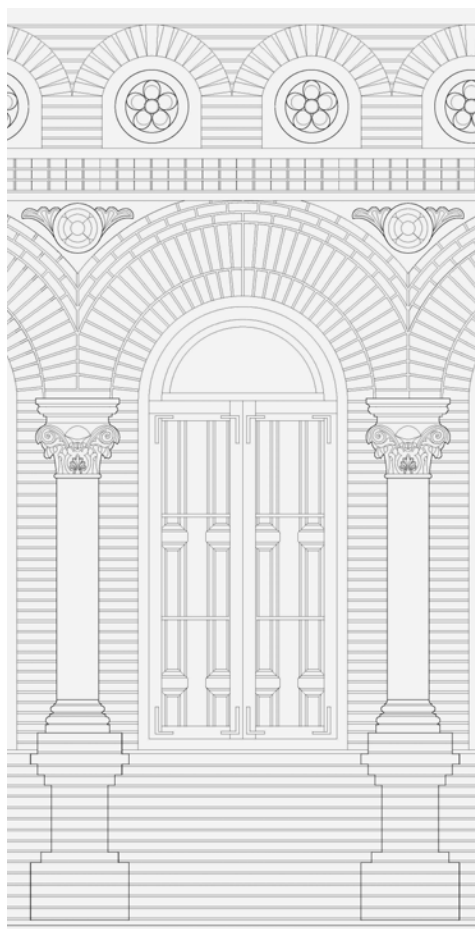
Asilos de la Duquesa de Sevillano. Detalle de fachada. Planta segunda.
